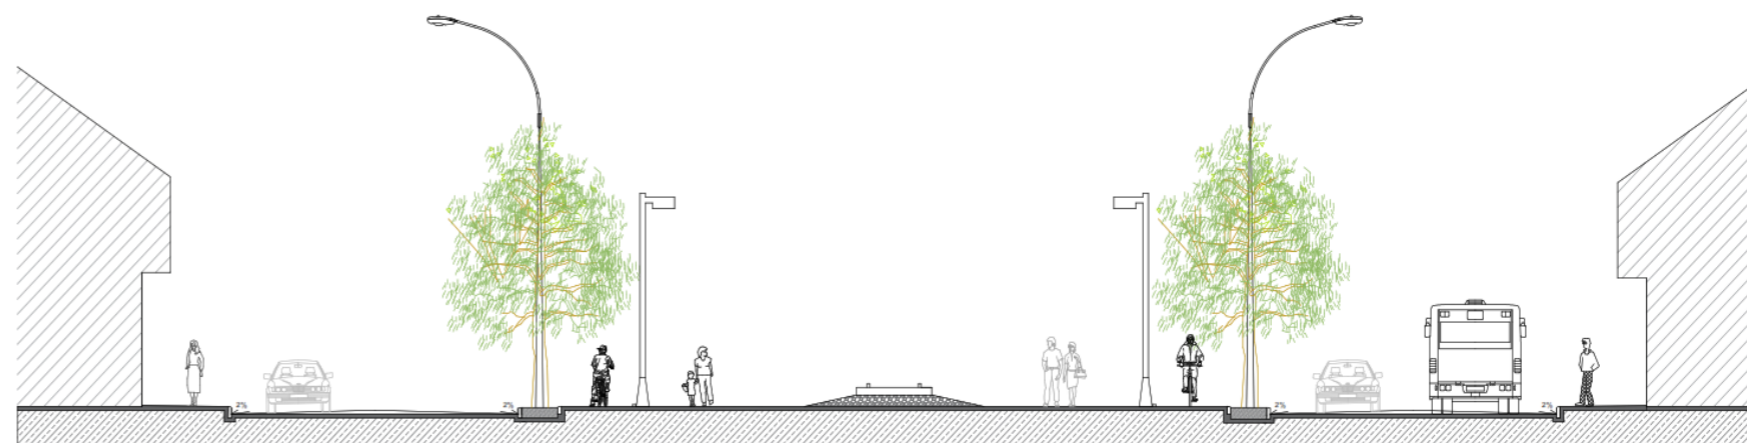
Planteamiento para una mejoraría en las vías cercanas al proyecto
